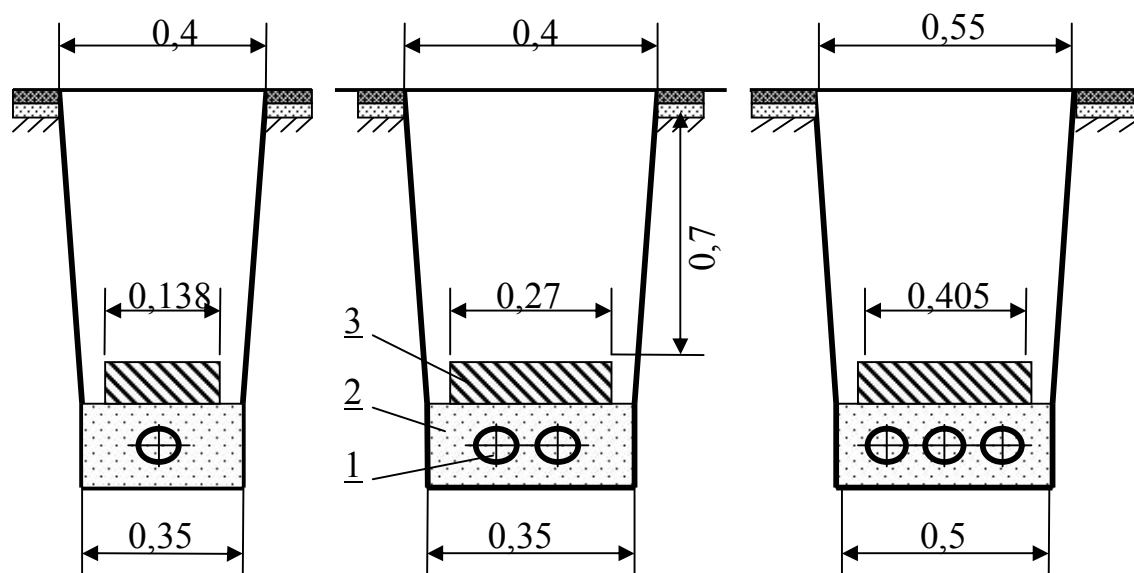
Прокладка кабеля в траншеях: 1 – кабель; 2 – песок или мелкая земля; 3 – кирпич
